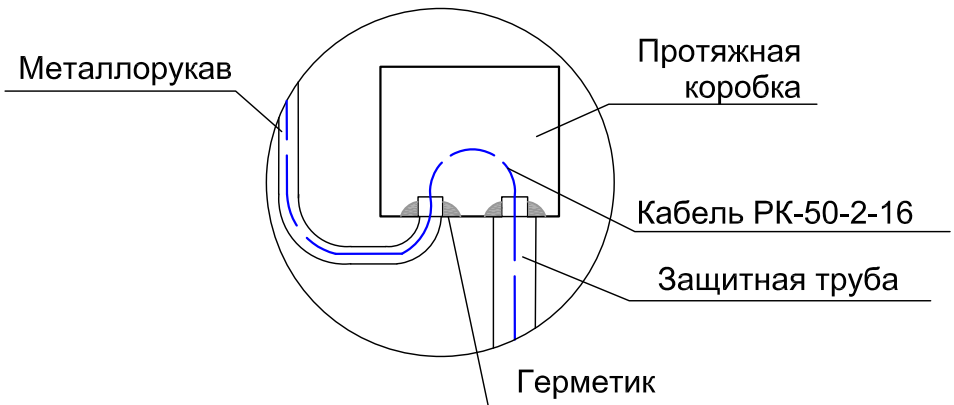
Прокладка соединительного кабеля через протяжную коробку
